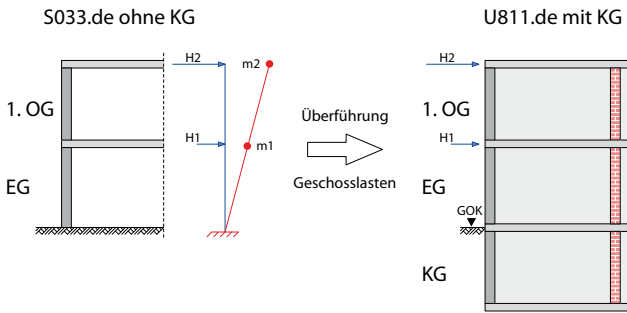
Beispiel: EG als erstes Geschoss mit Belastung
